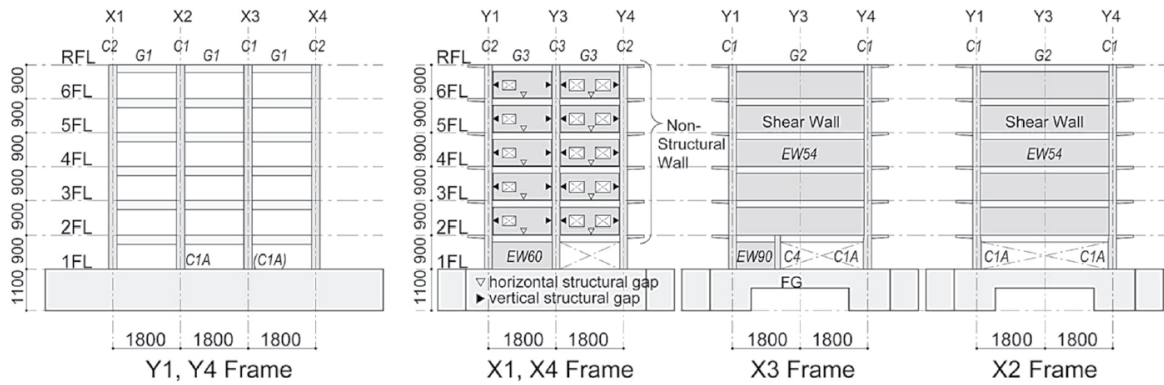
試験体軸組図 (単位 : mm) 2.1)
